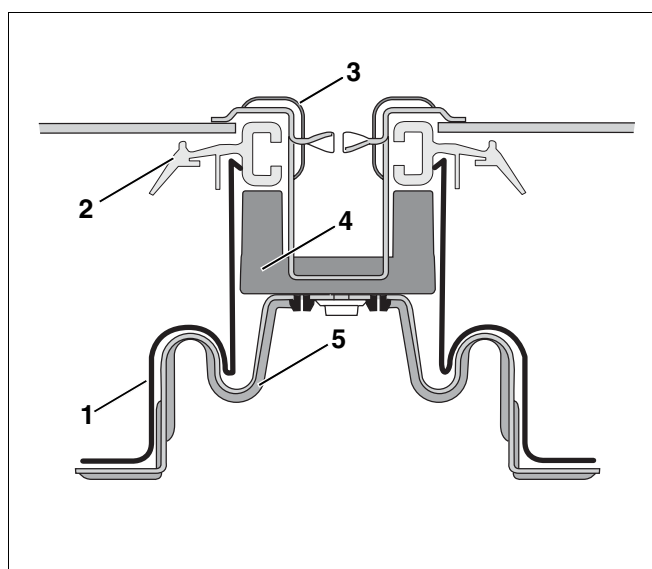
Esquema de los dispositivos de sujeción del colector con dispositivo de apriete doble
